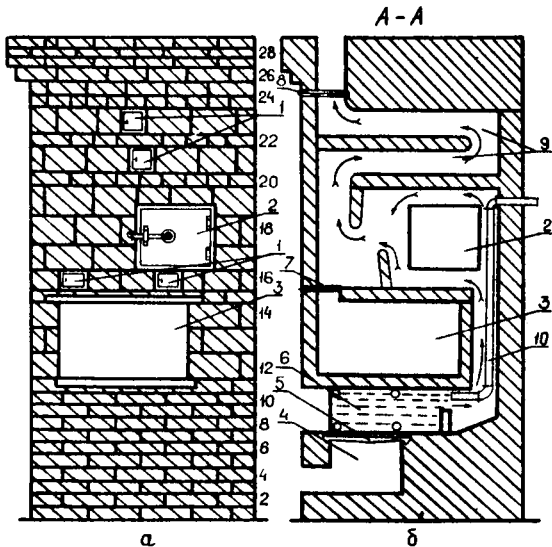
Печь отопительно-варочная № 11, вид спереди (а) и разрез по линии А — А (б): 1 — окна чистки; 2 — духовка; 3 — варочная камера; 4 — зольник; 5 — колосники; 6 — резервуар для воды; 7 — задвижка вытяжного канала; 8 — задвижка зимняя; 9 — горизонтальные дымообороты; 10 — труба горячей воды
